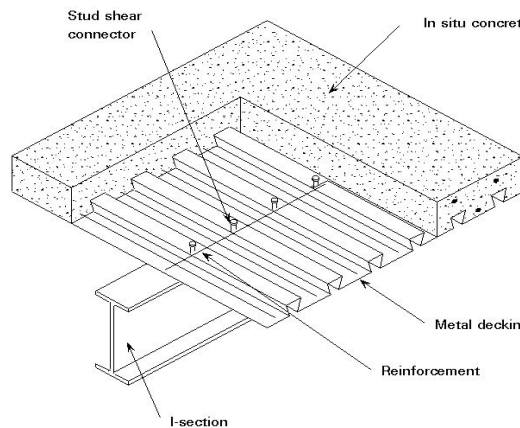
exemple de plancher mixte acier béton avec dalle mixte connectée à une poutre métallique
